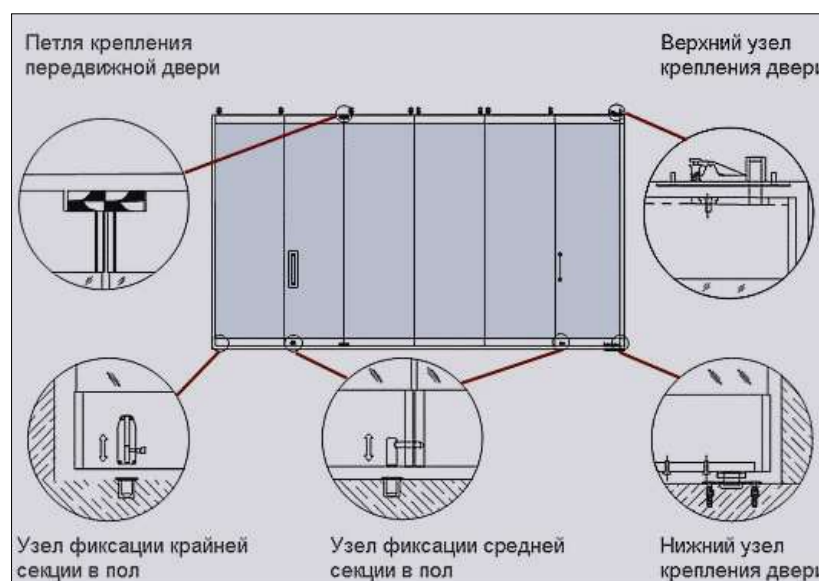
Схема крепления стеклянных перегородок.
